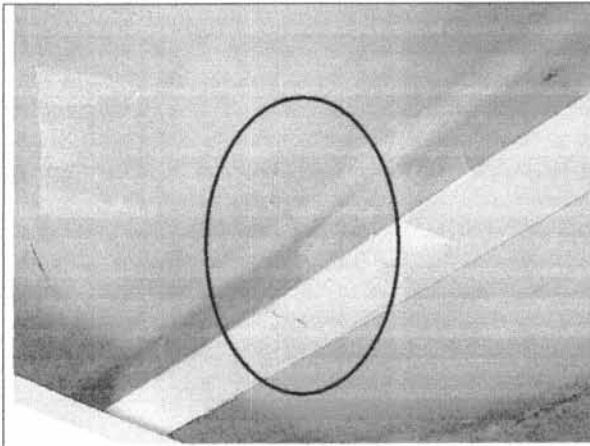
Fisura en la viga ubicada en el costado norte del inmueble - placa del piso 2.
